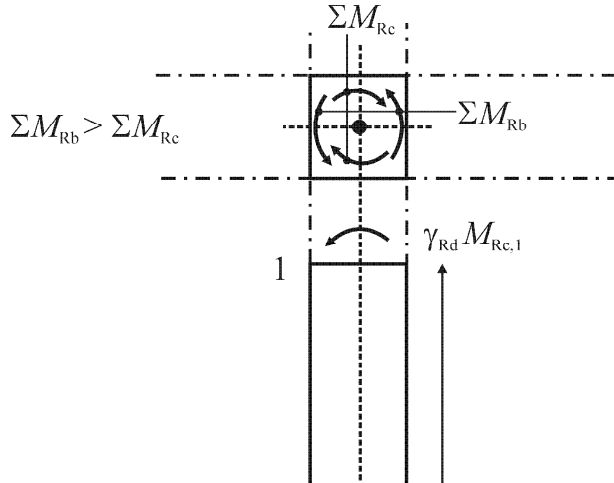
Moments $M_{i,d}$ dans la section 1 du poteau pour le calcul de l'effort tranchant sollicitant de calcul du poteau dans le cas « poutres fortes – poteaux faibles ».
